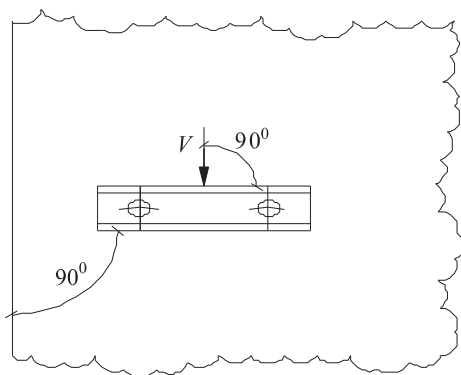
剪力荷载方向与混凝土基材自由边缘的夹角
